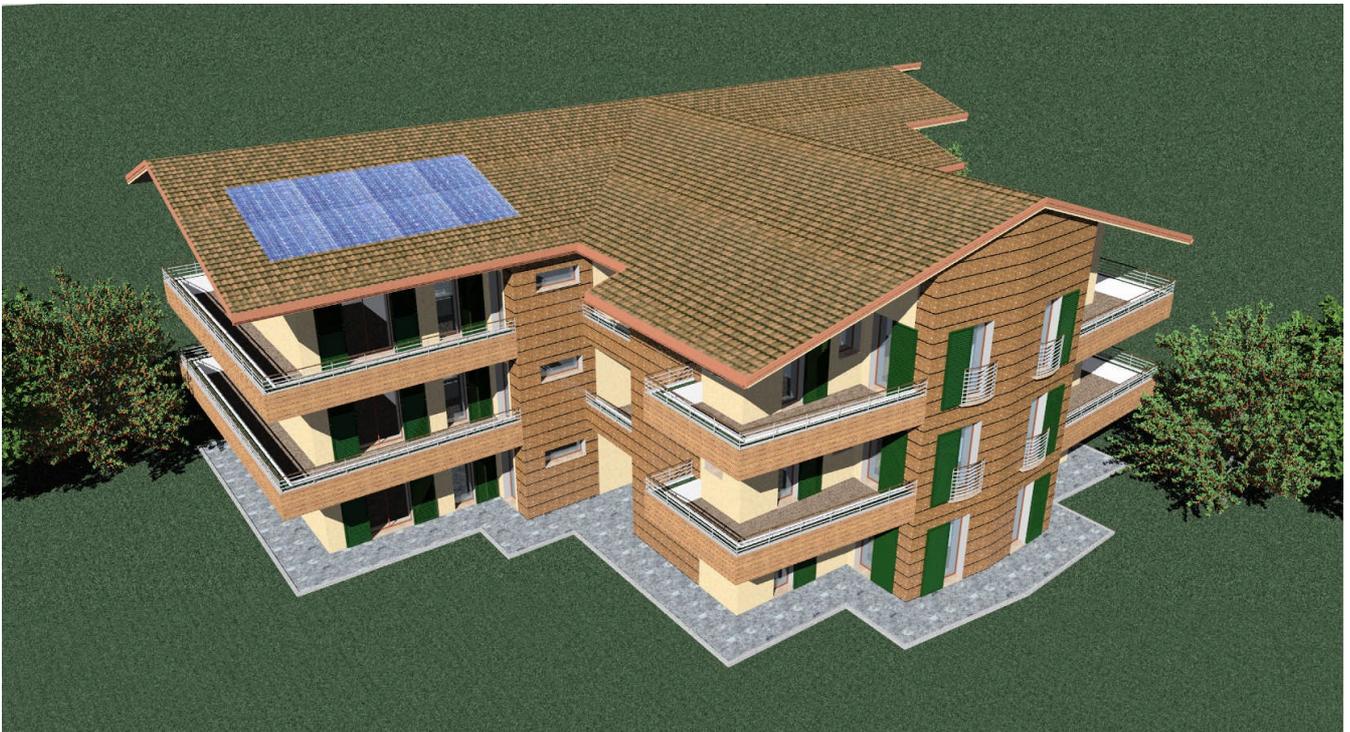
Ricostruzione tridimensionale dell'edificio in oggetto
